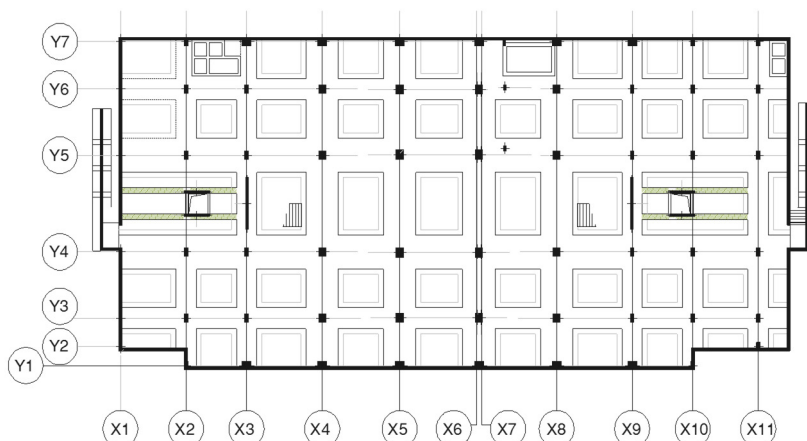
Planta de fundações com alinhamentos dos pilares principais.
